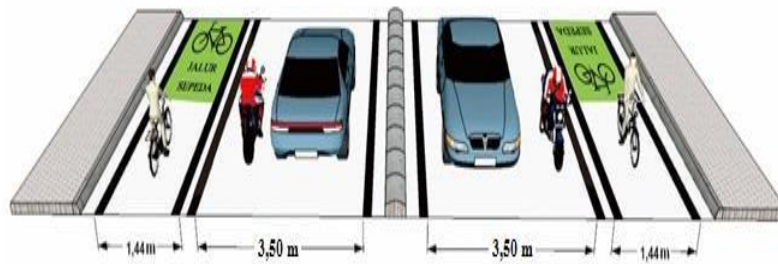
Denah lajur sepeda tipe B di trotoar
